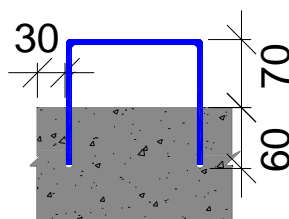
Detalhe da seção do pilar com armadura de reforço
